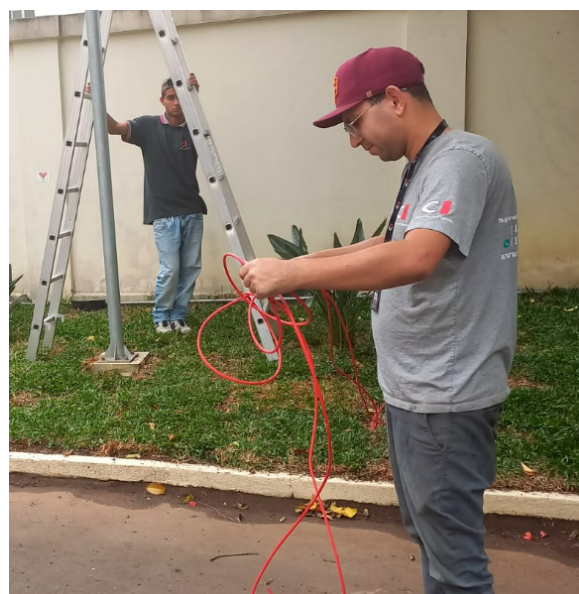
Implantação de estrutura de cabeamento estruturado área externa.
